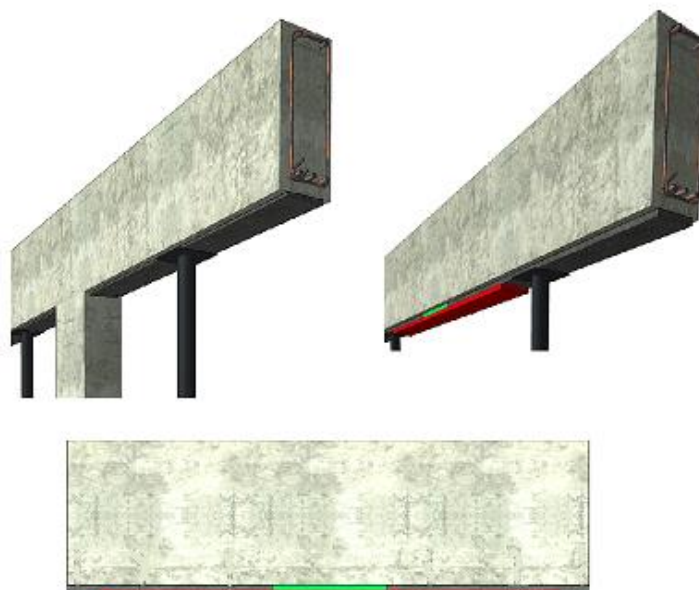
Reforço com perfil metálico fixado na lateral da viga
